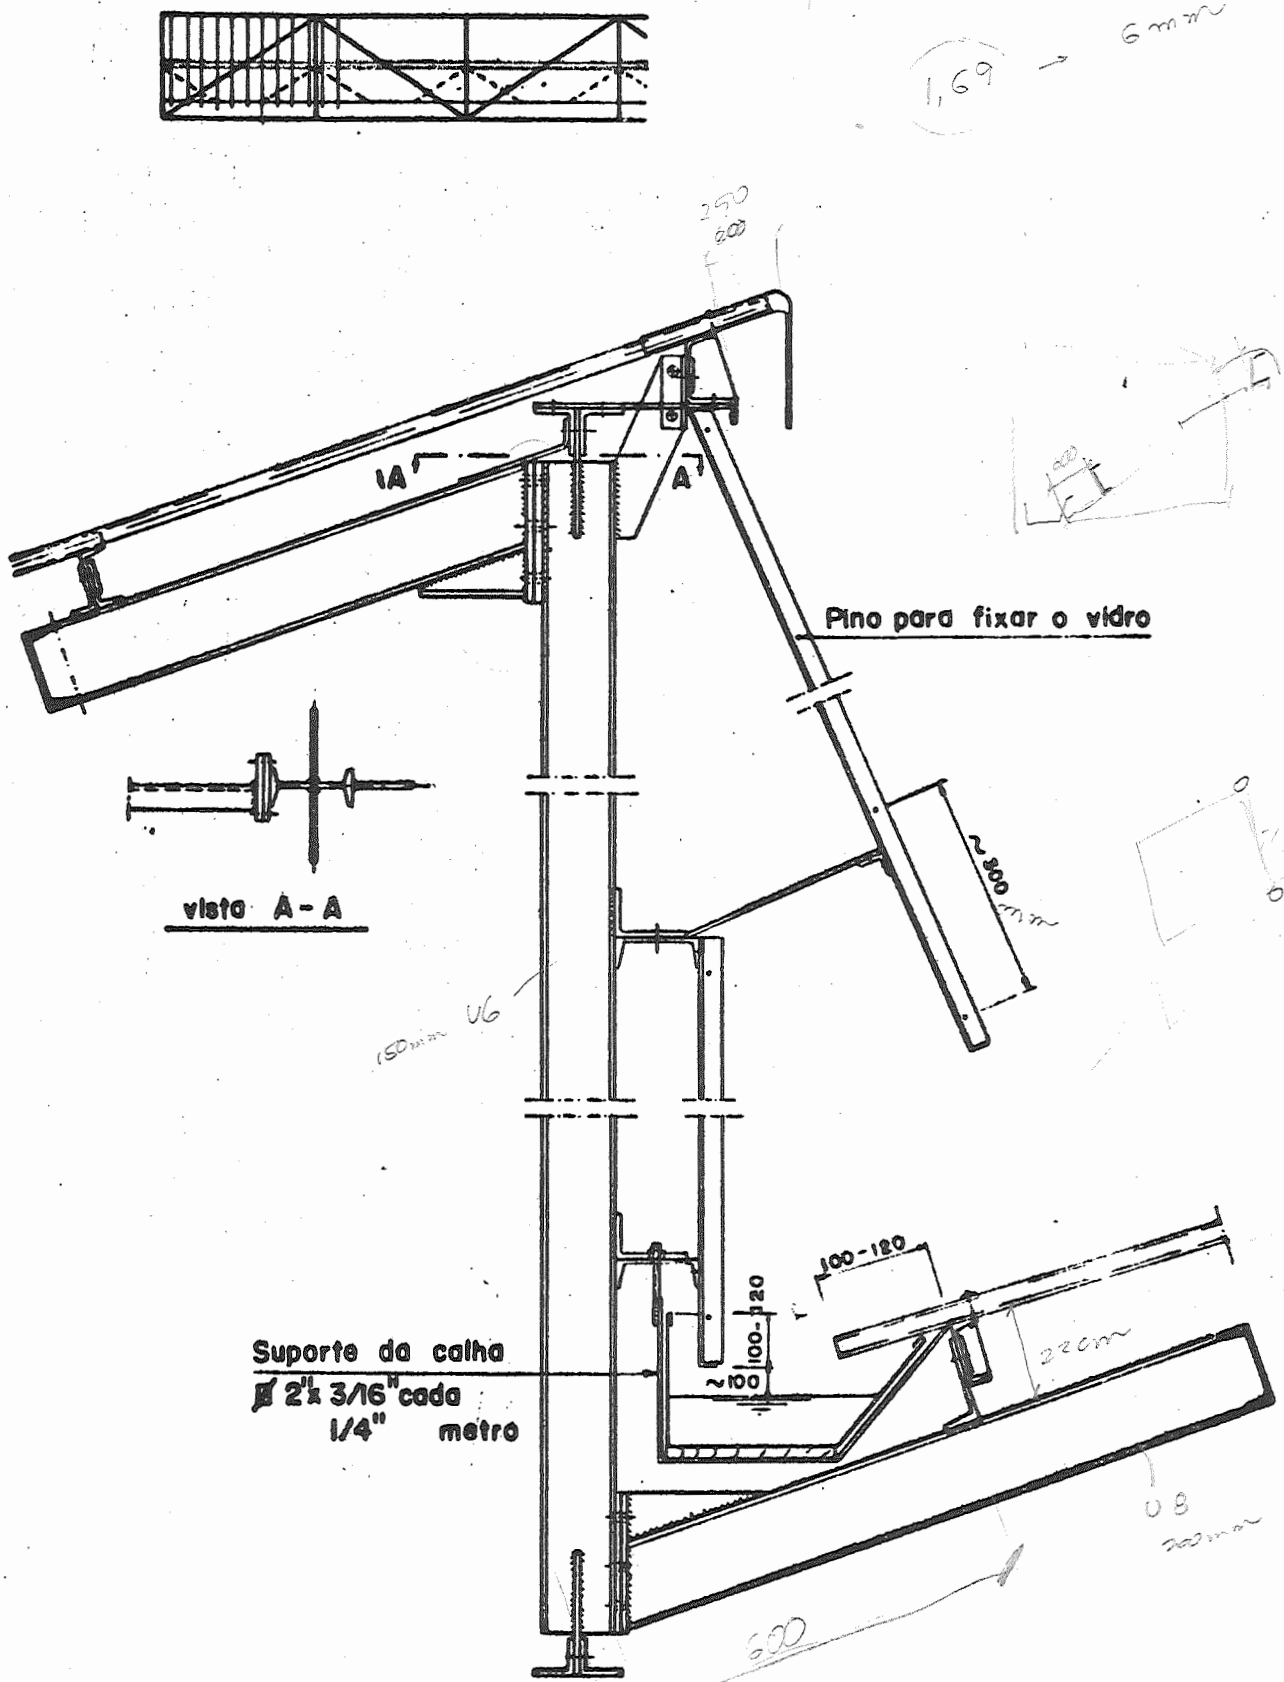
Traves do telhado em alma cheia engastadas no montante
